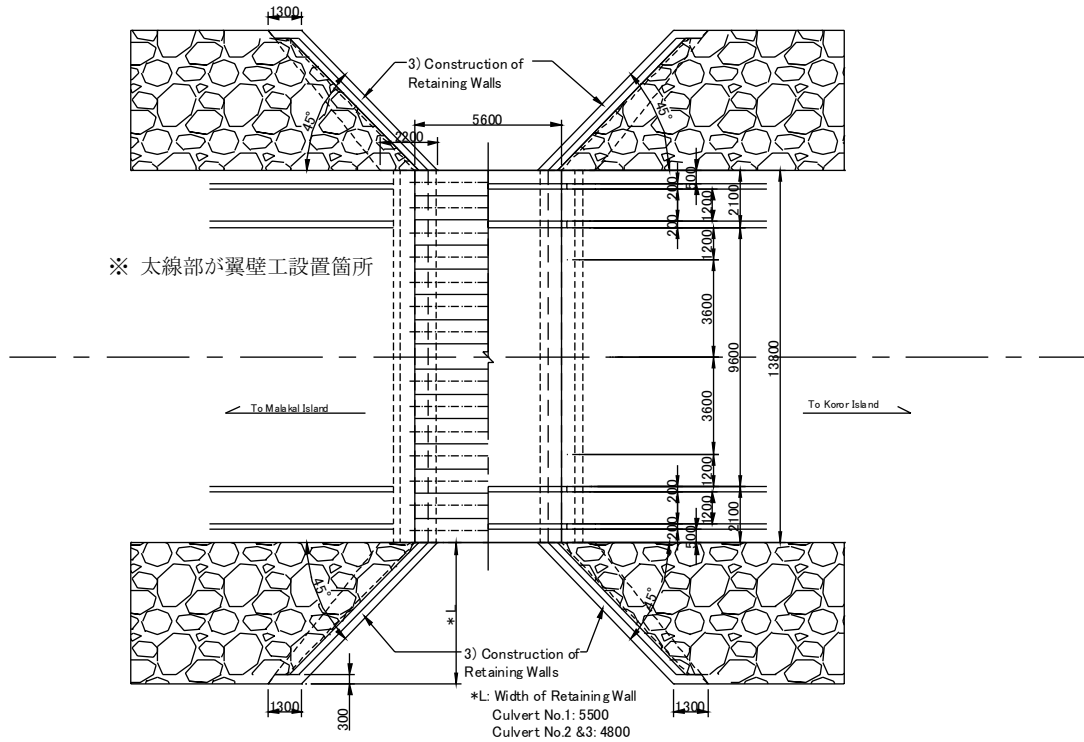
カルバート平面図 (マラカルコースウェイ上)
